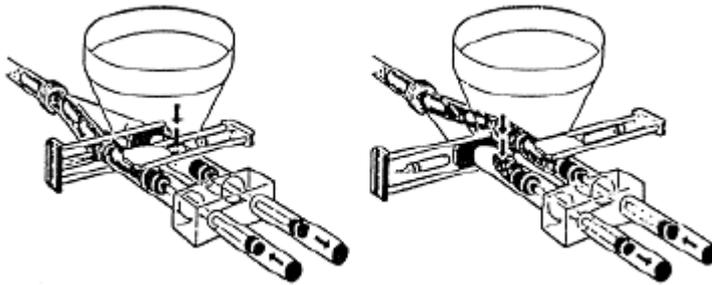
Kolbenpumpe [10], gefunden in [2], S. 425
